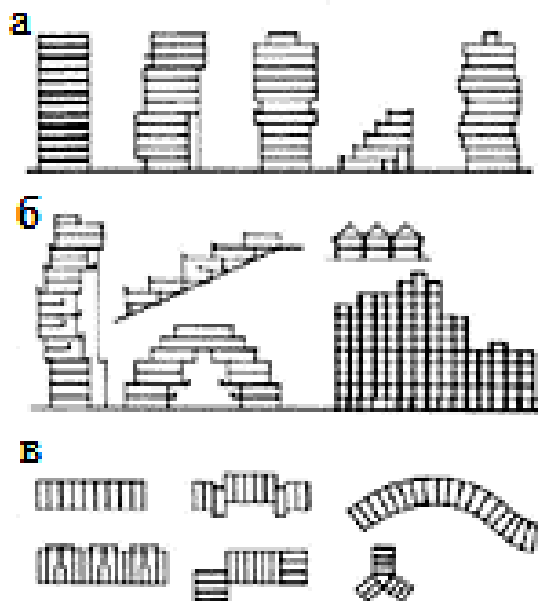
Варіант об'ємної побудови будівлі з поперечними несучими стінами: а – розрізи; б – силуети; в – плани
